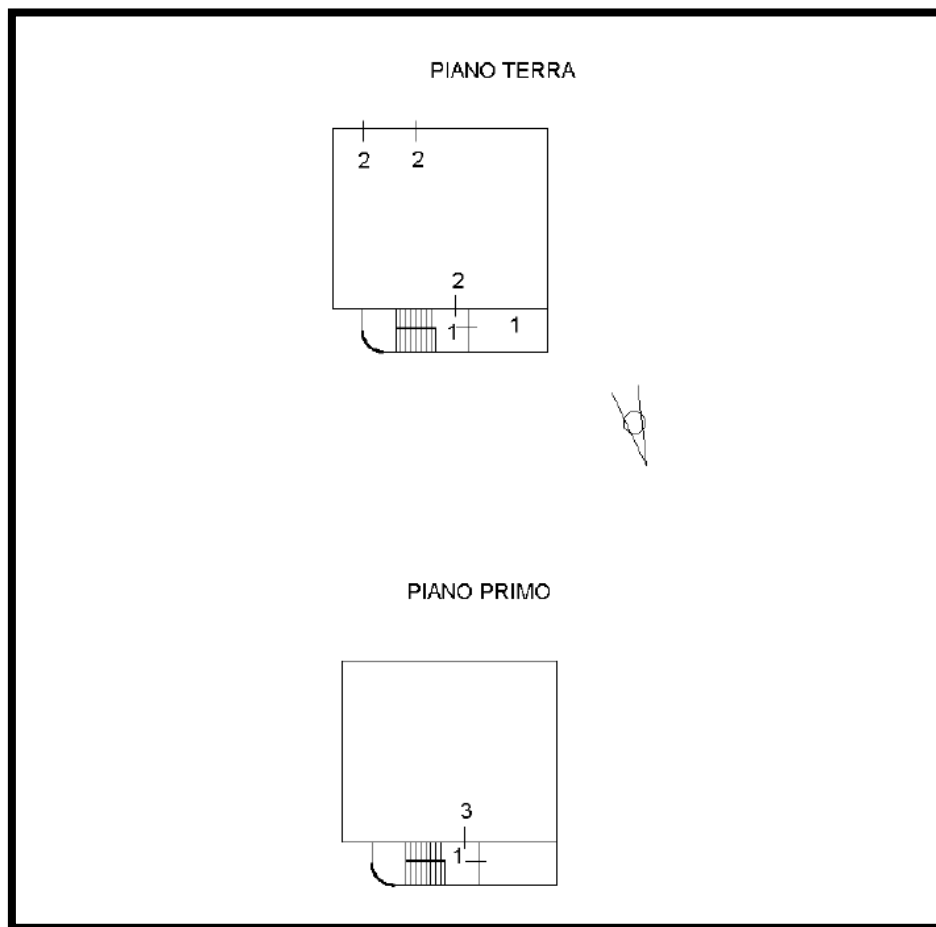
Stralcio elaborato planimetrico particella 675
